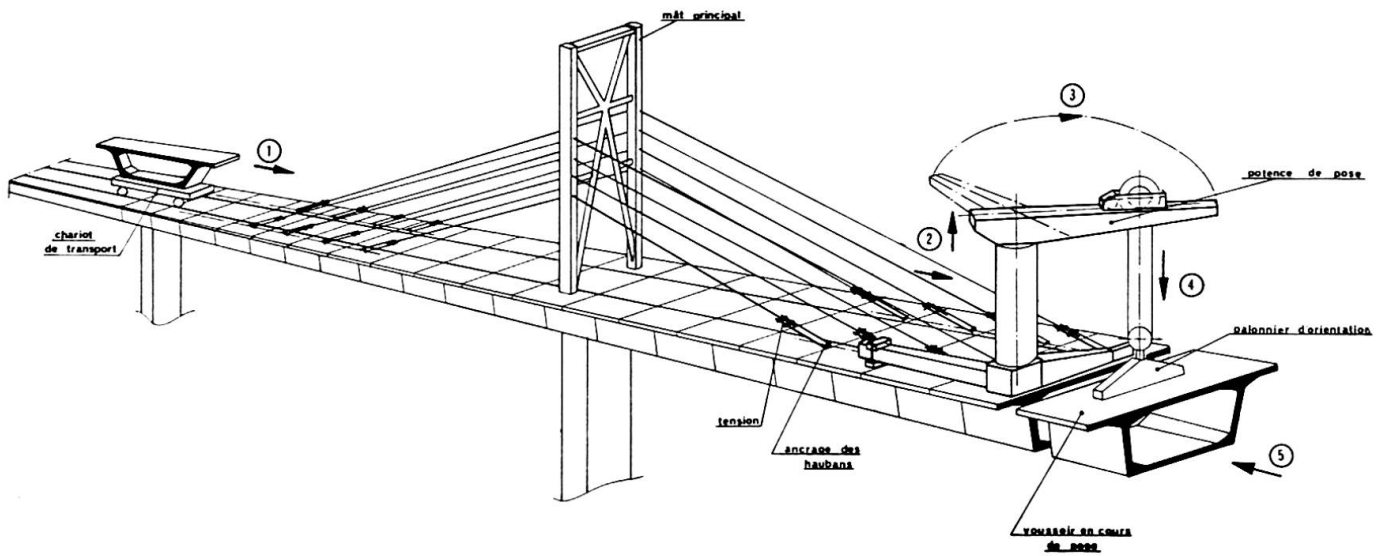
CONSTRUCTION A L'AVANCEMENT
